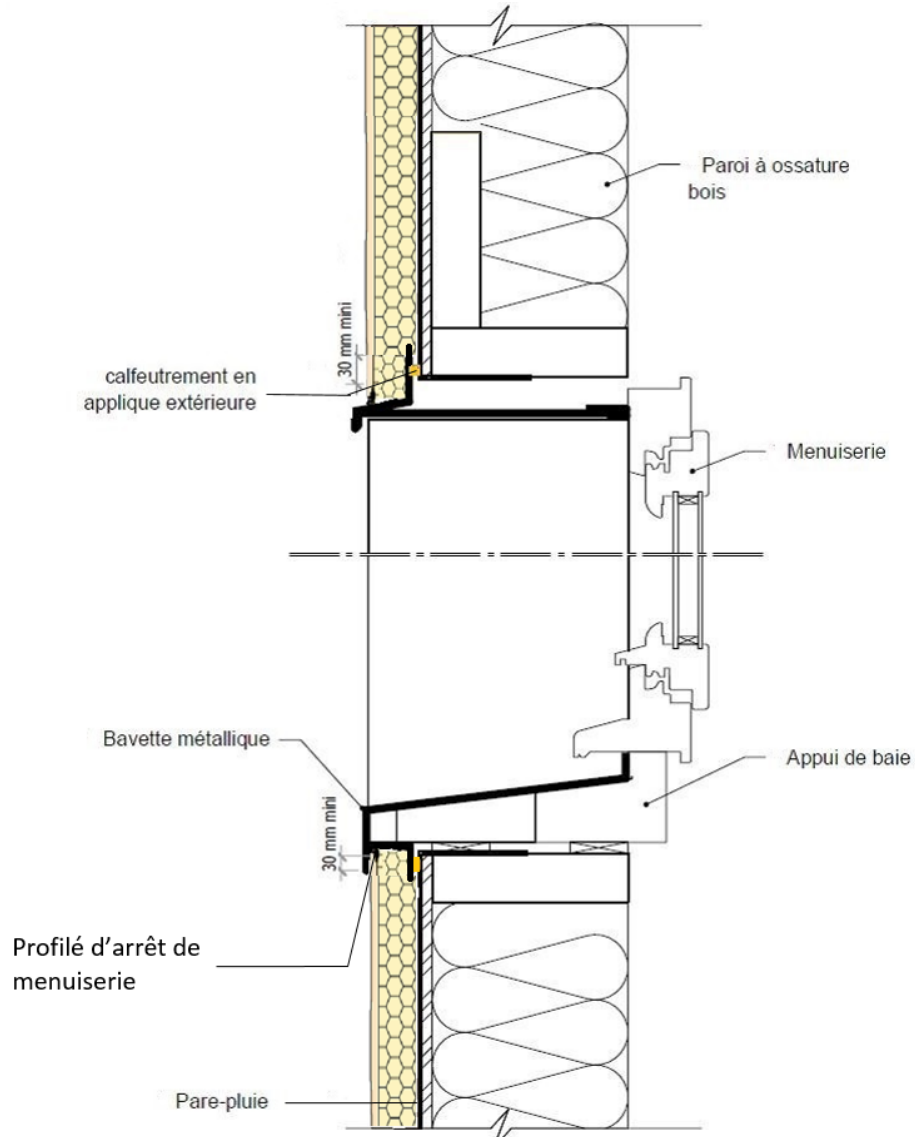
Encadrement de baie rapporté (Ee2) – coupe verticale
